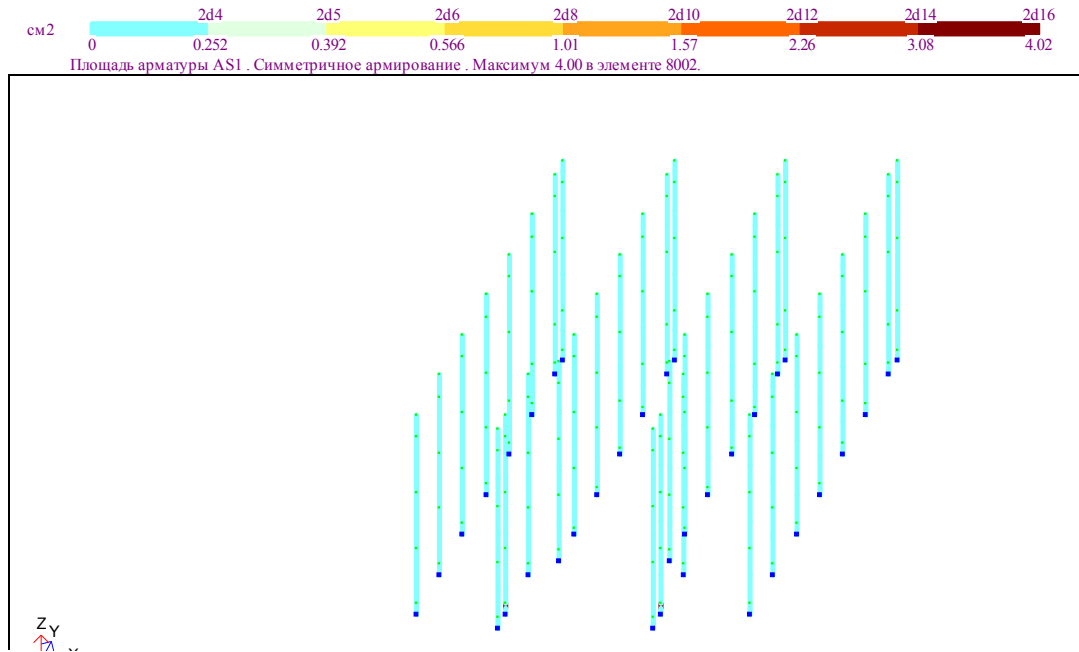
Площа подовжньої арматури у нижньої грані перетину з
